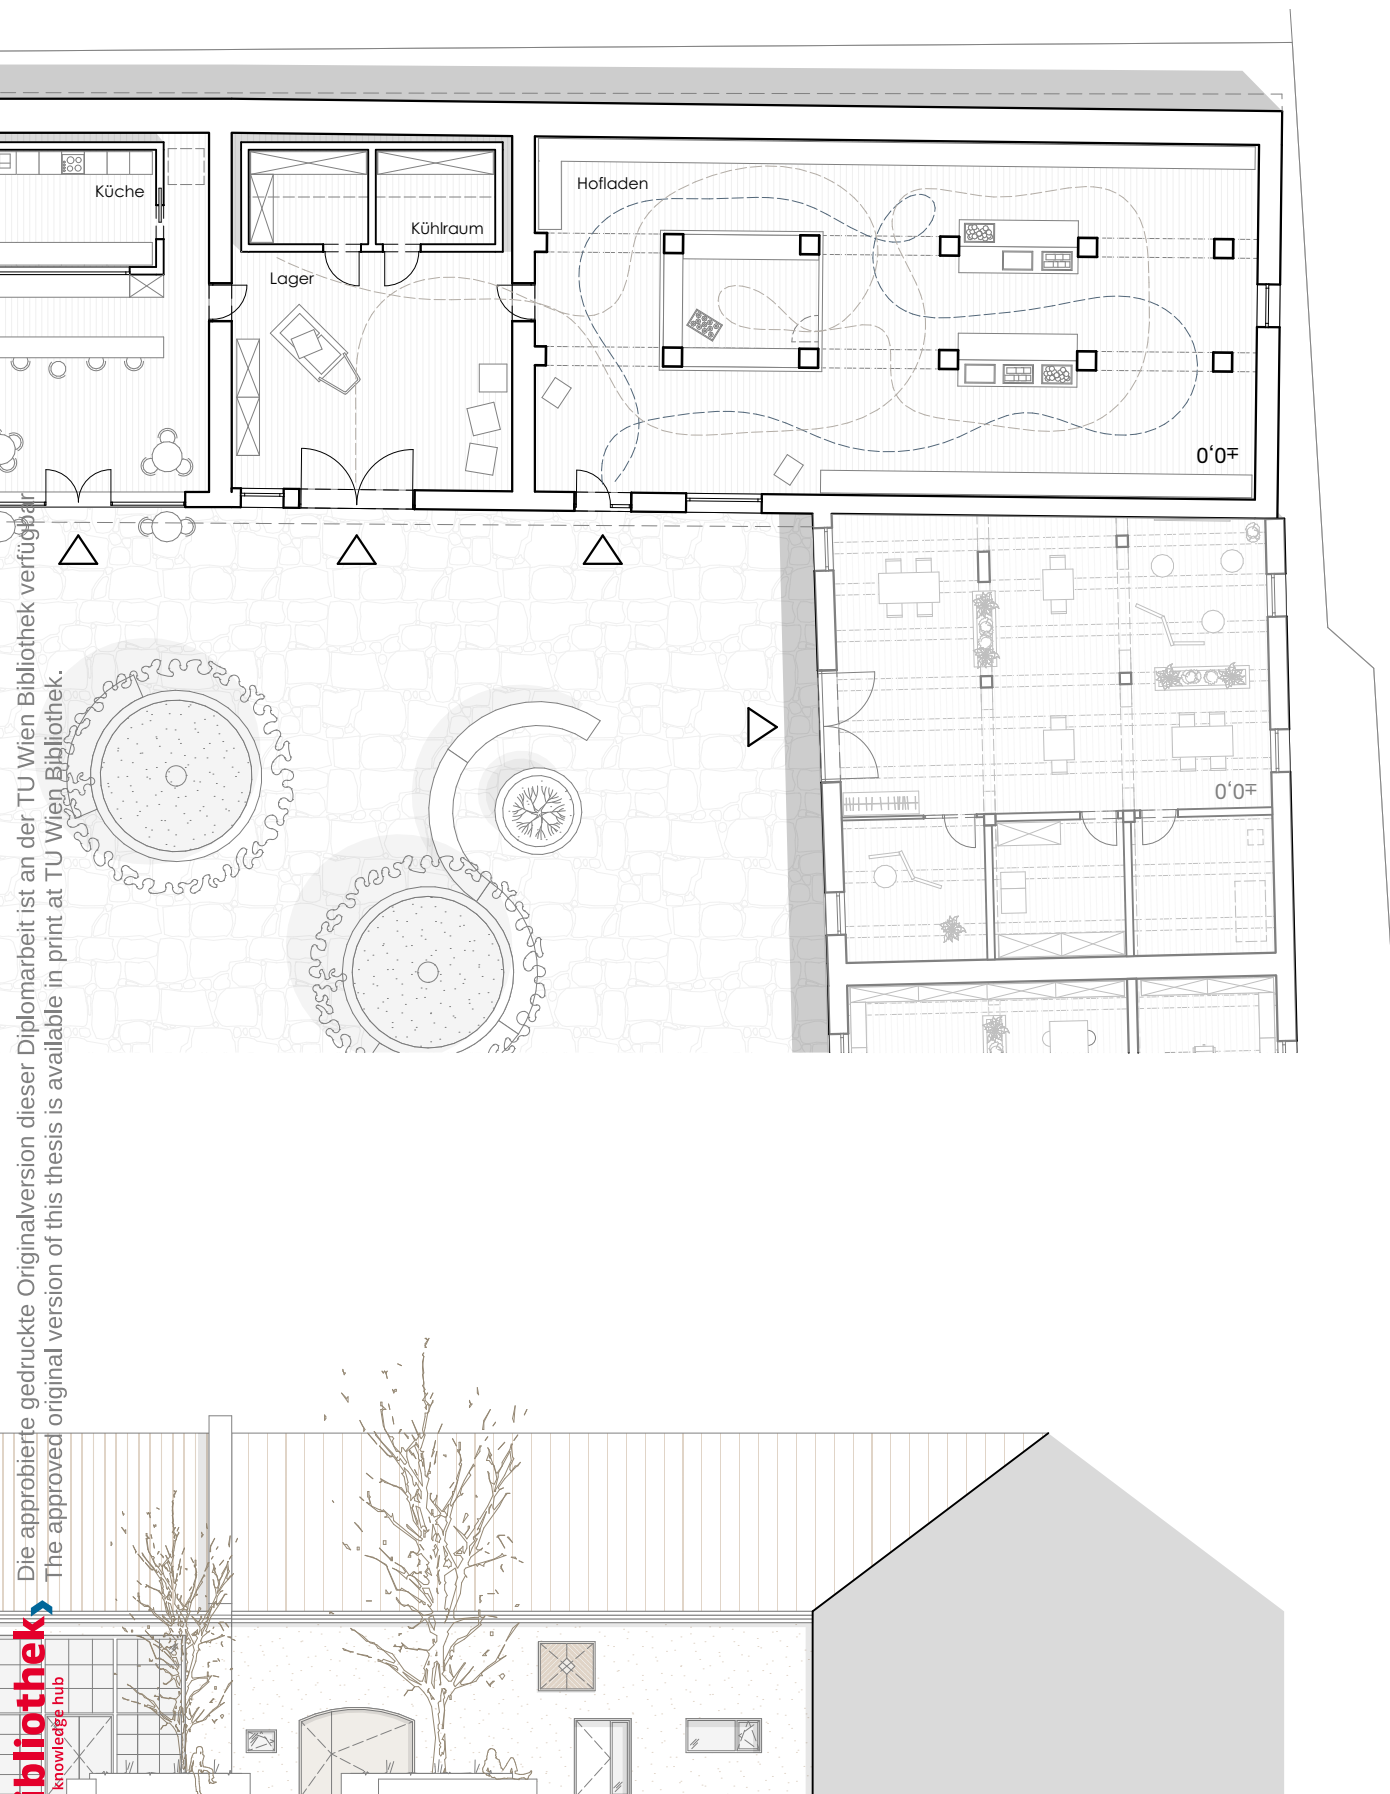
Grundrissausschnitt EG | Hofansicht, Museum, M.1:200
